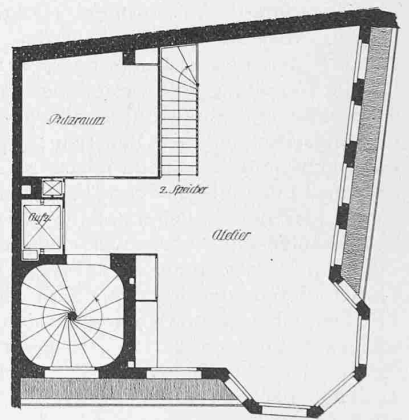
bis 4. Grundrisse der vier Stockwerke des Geschäftshauses «zum blauen Störchli». — Masstab 1 : 150.
